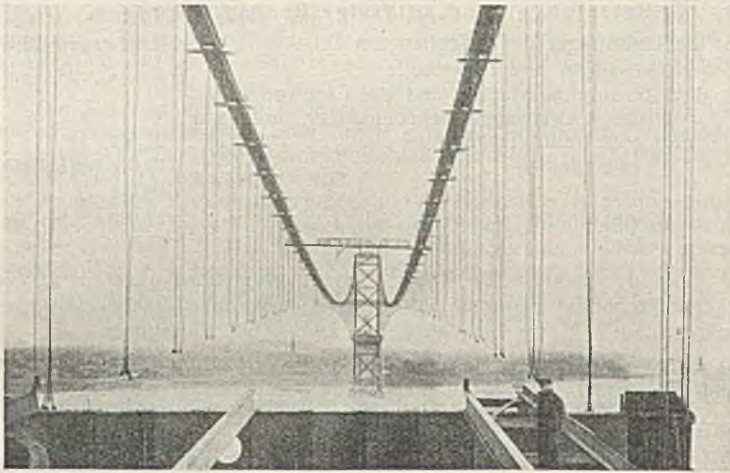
Die Fußstege sind an den Kabeln festgebunden. Im Vordergrund ist der erste aufgehängte Querträger sichtbar.
